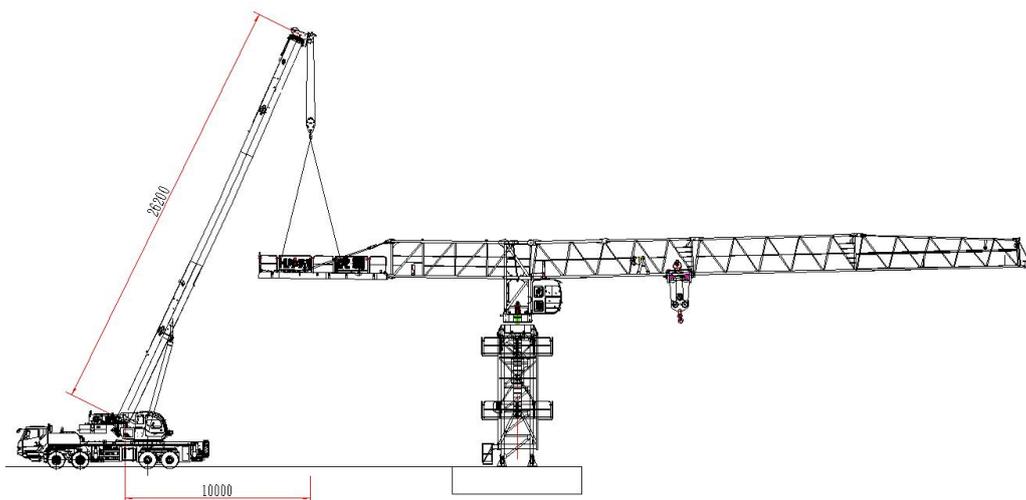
平衡臂臂节二拆除立面图（单位：mm）
